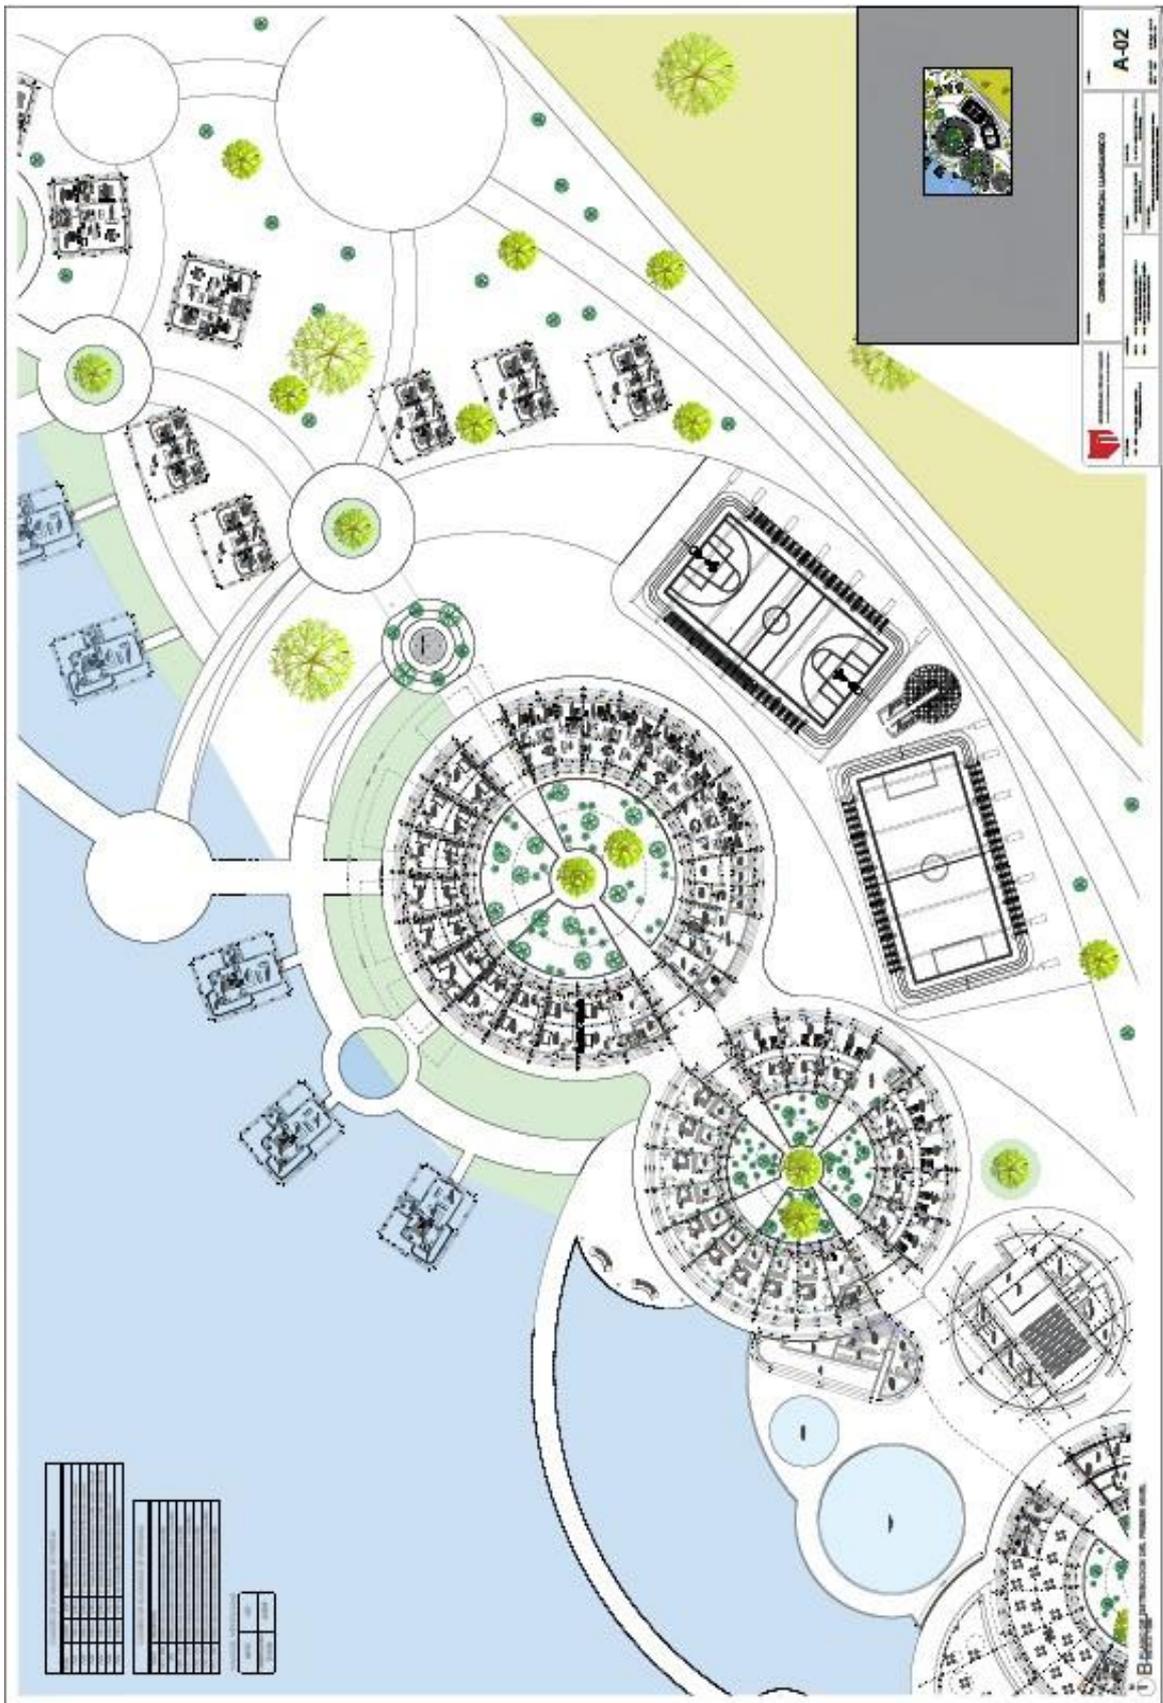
Plano de distribución por sectores y niveles. Fuente: elaboración propia
